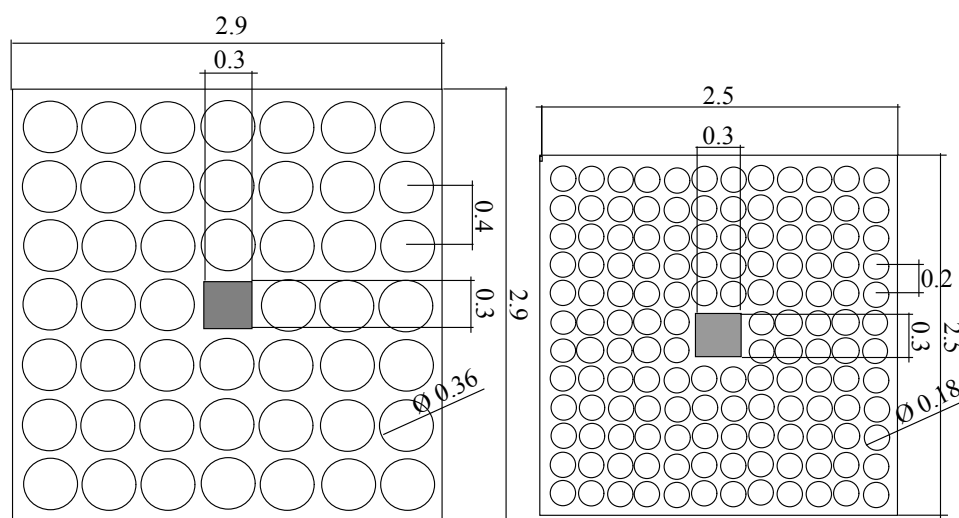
Dimensões das lajes ensaiadas, Held (2002)
